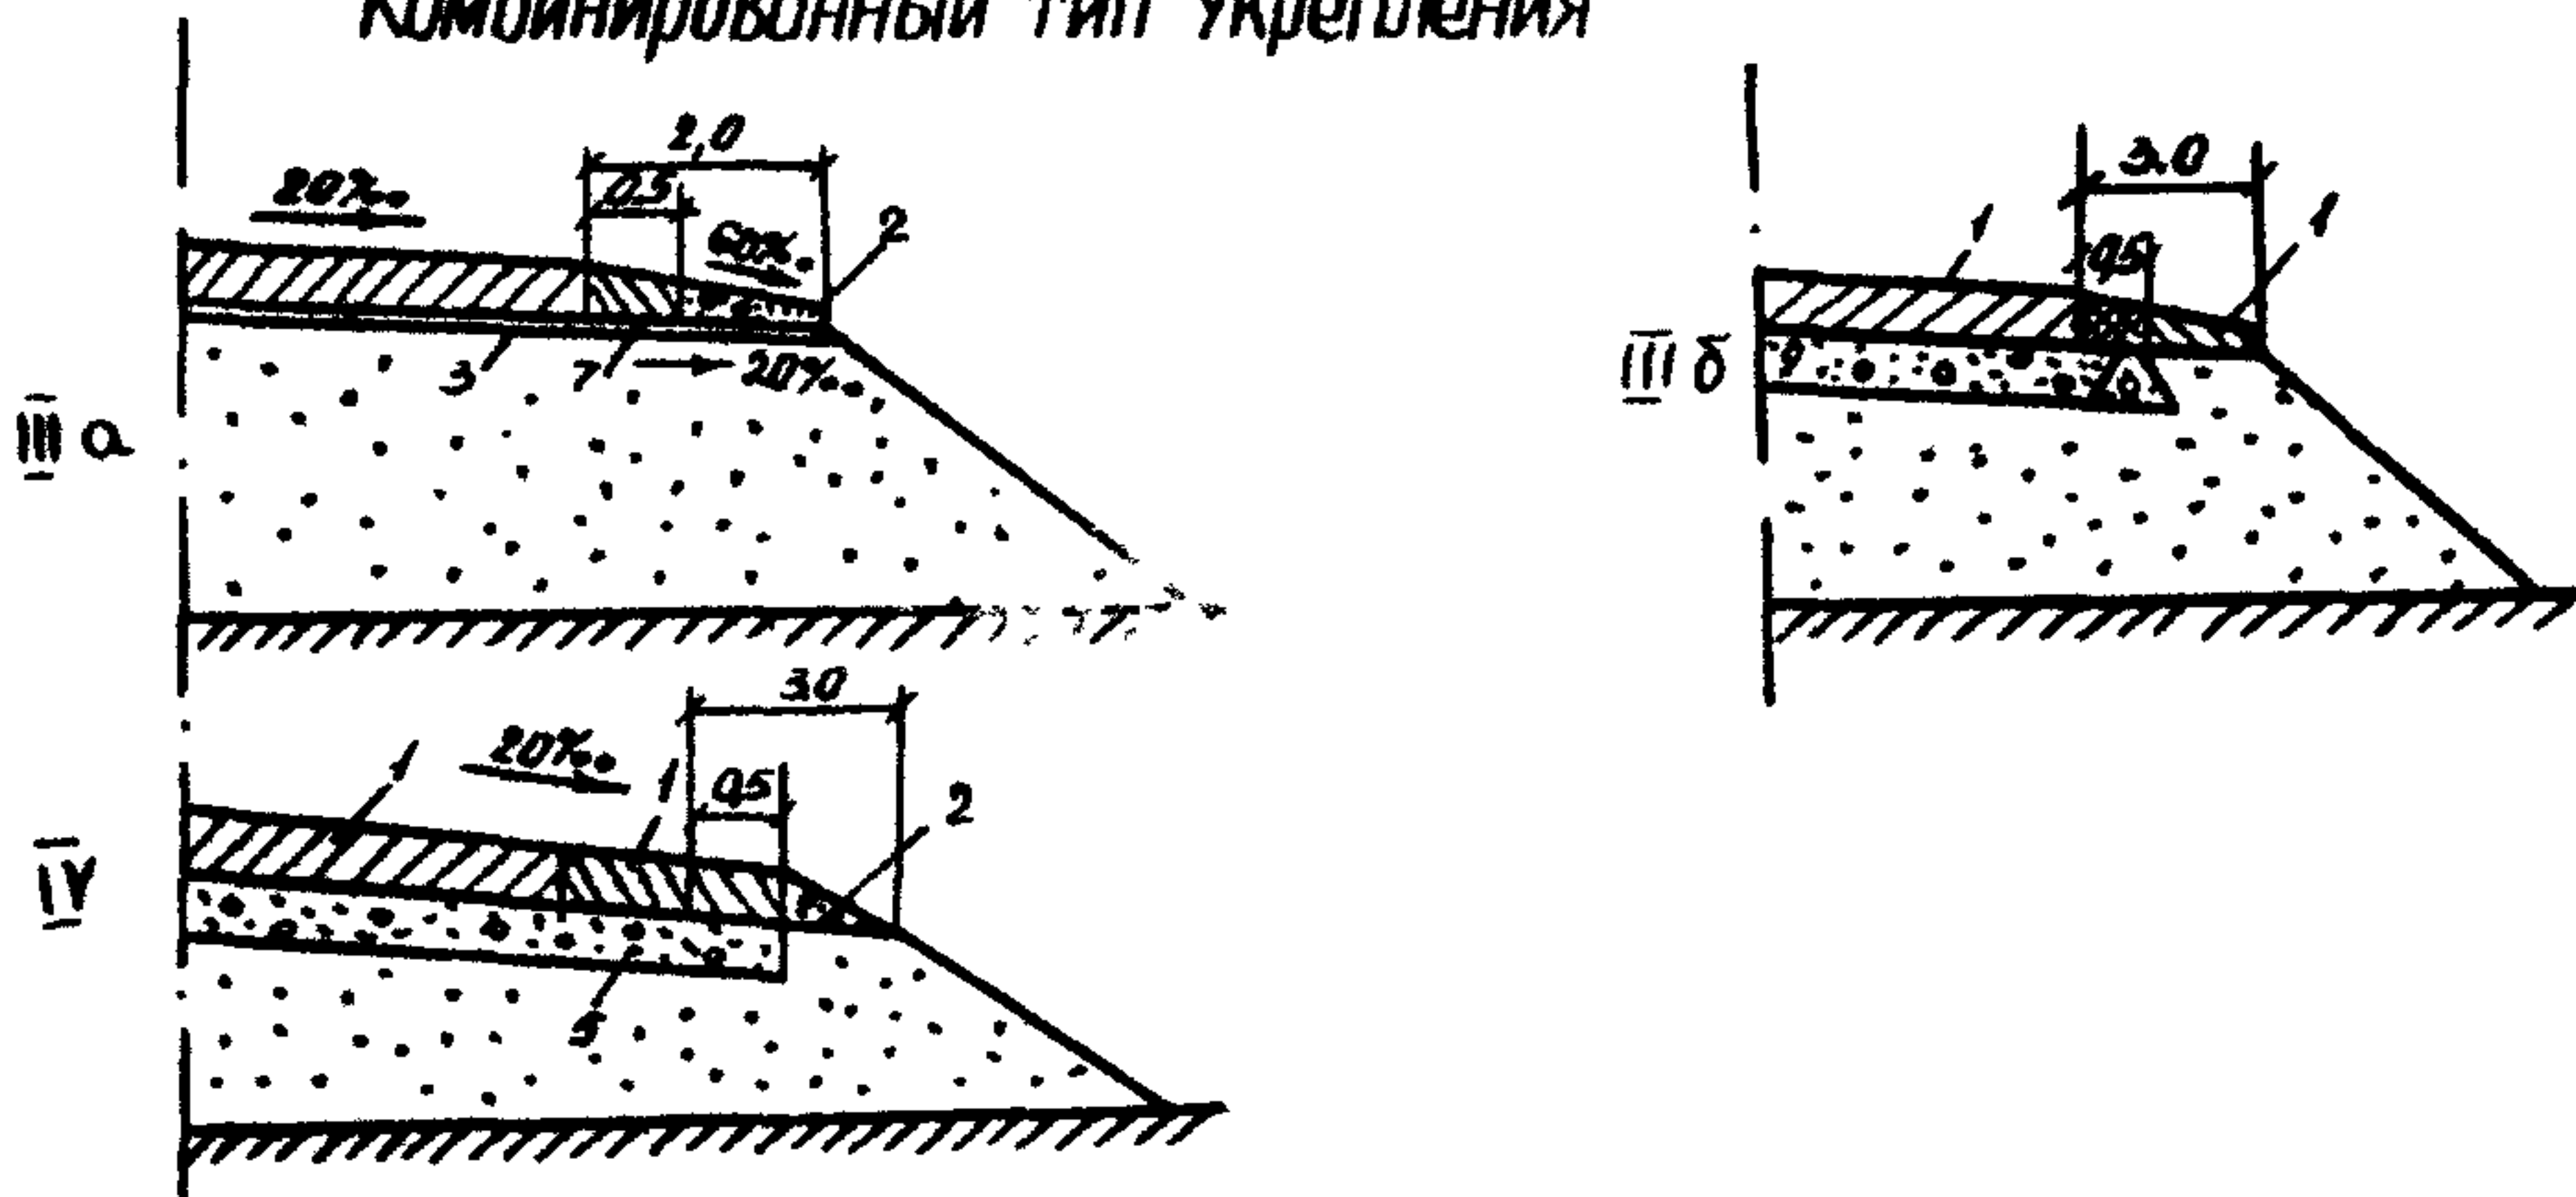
Схемы конструкций укрепления обочин: нежесткий тип укрепления; комбинированный тип укрепления:
